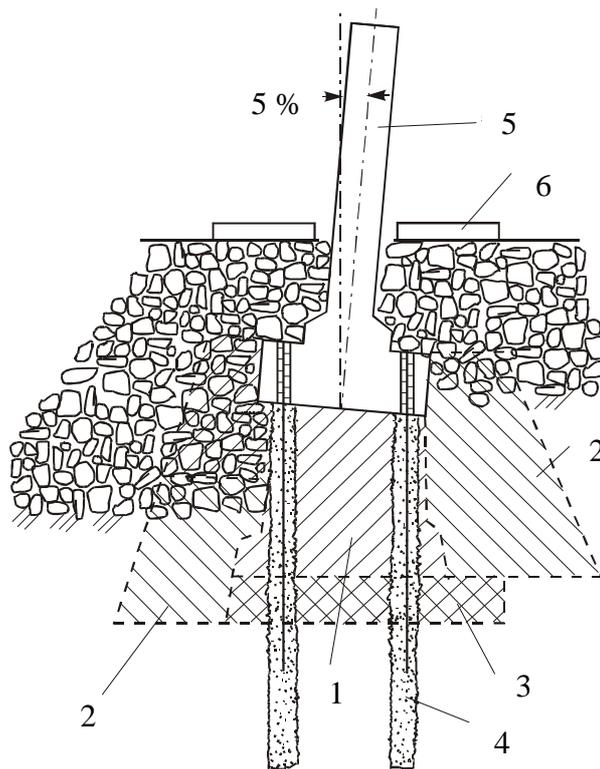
Усиление фундамента мостовой опоры с использованием струйной технологии: 1, 2, 3 – соответствующие фазы закрепления грунта; 4 – опоры с армированием, устроенные при помощи струйной технологии; 5 – опора моста; 6 – бетонная отмостка
